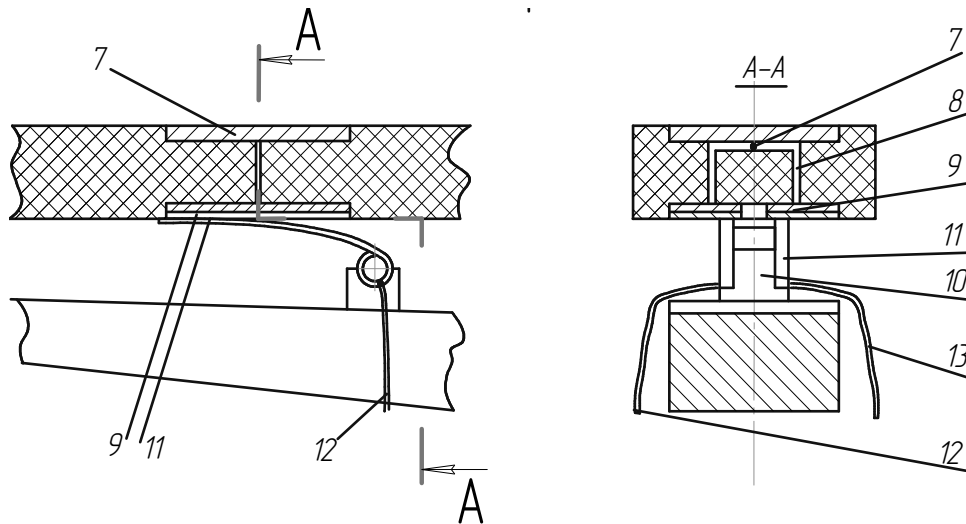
Конструкція ТП: а) загальний вигляд; б) вигляд А-А на загальний вигляд
